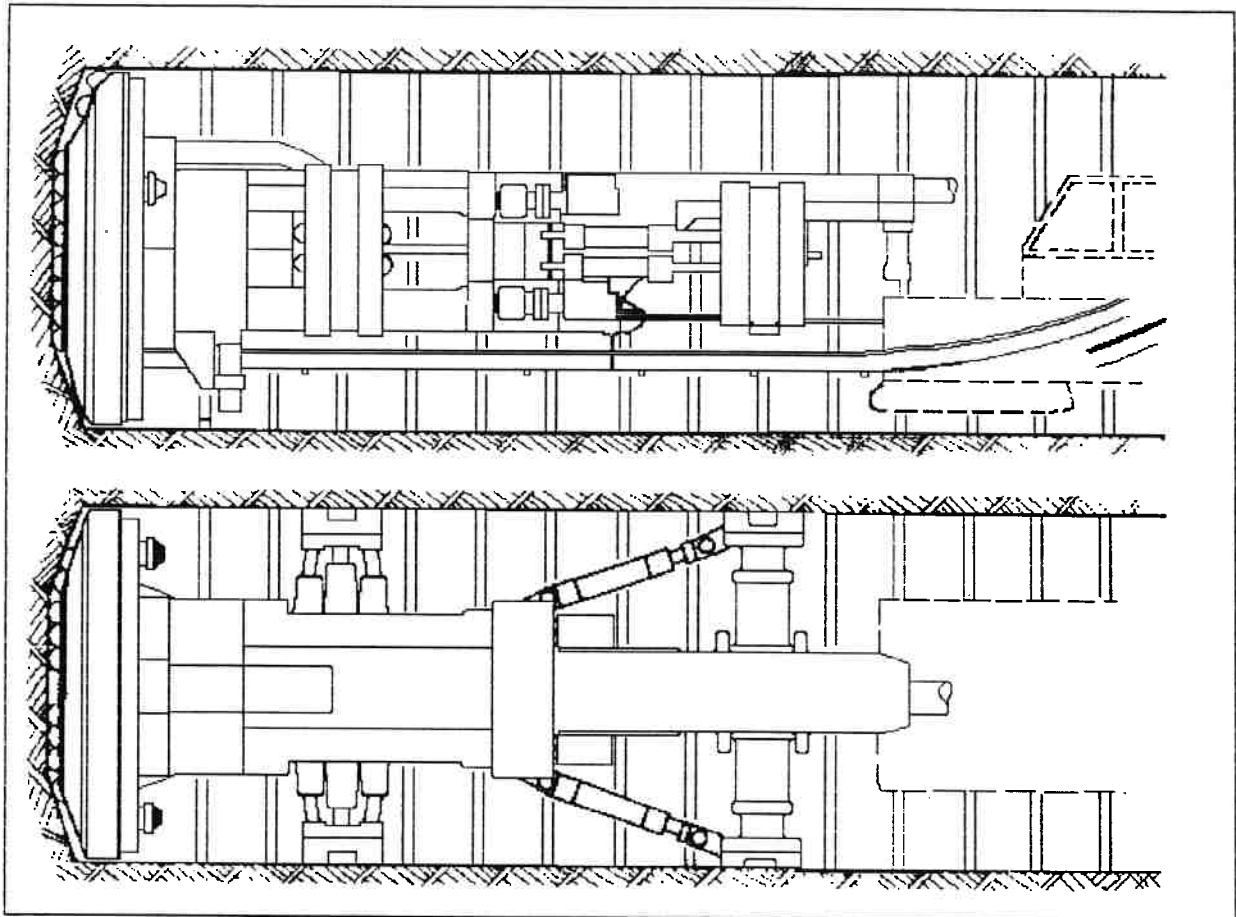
Elevação (acima) e planta (abaixo) de uma máquina de corte integral. (HENNIES; AYRES DA SILVA, 1995)
